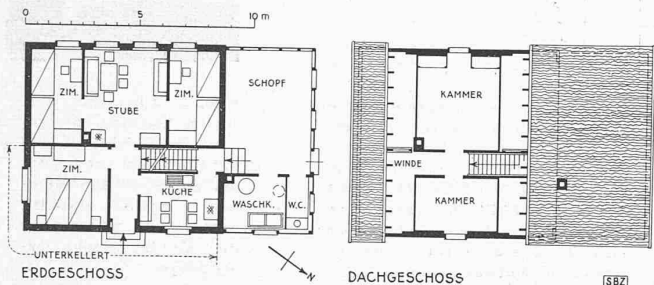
Hausgrundrisse 1 : 300 der «Klostersiedlung» Dättnu
